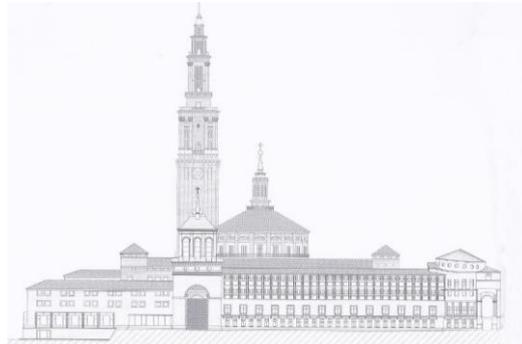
Alzado de la Fachada Principal (Este). Acceso al Conjunto.
